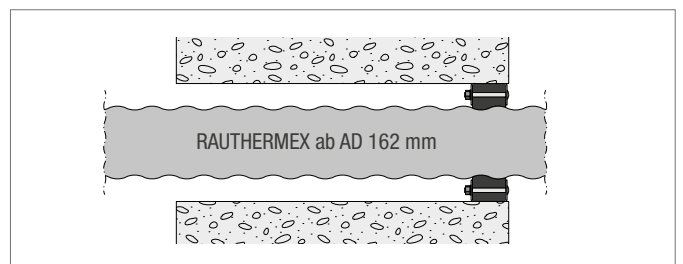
Hauseinführung mit Mauerdichtflansch FA 40
